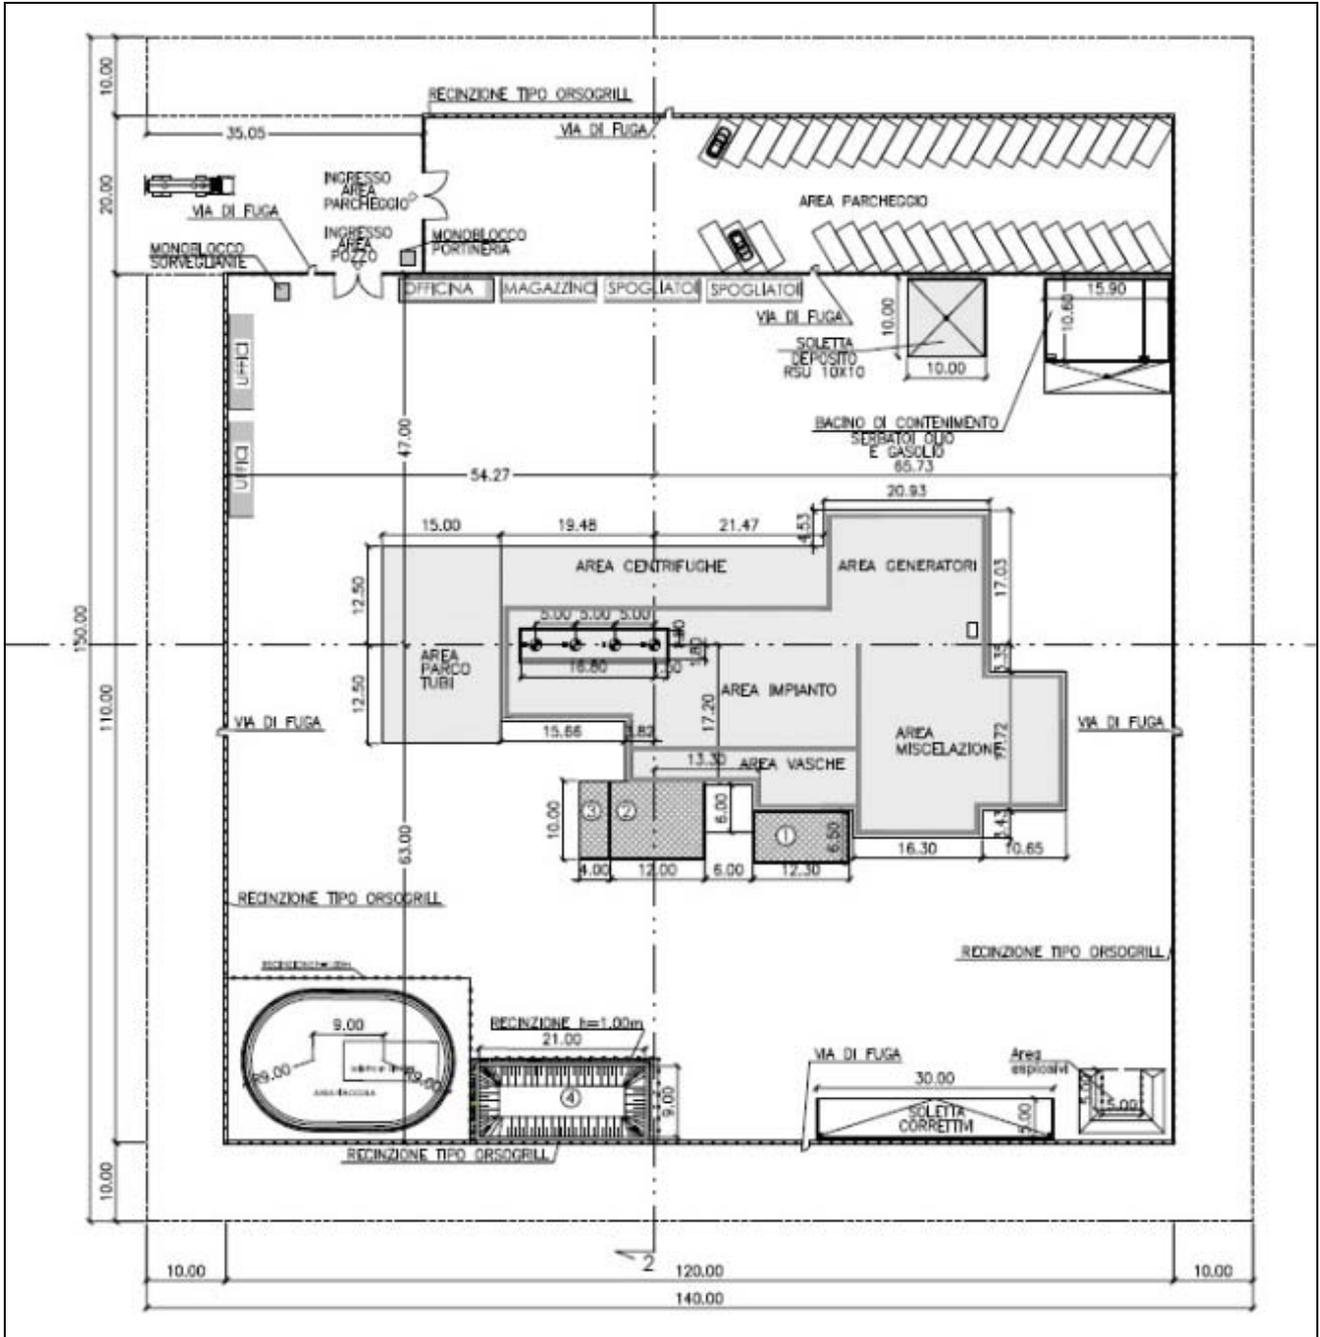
Area di Perforazione, Planimetria di Progetto
